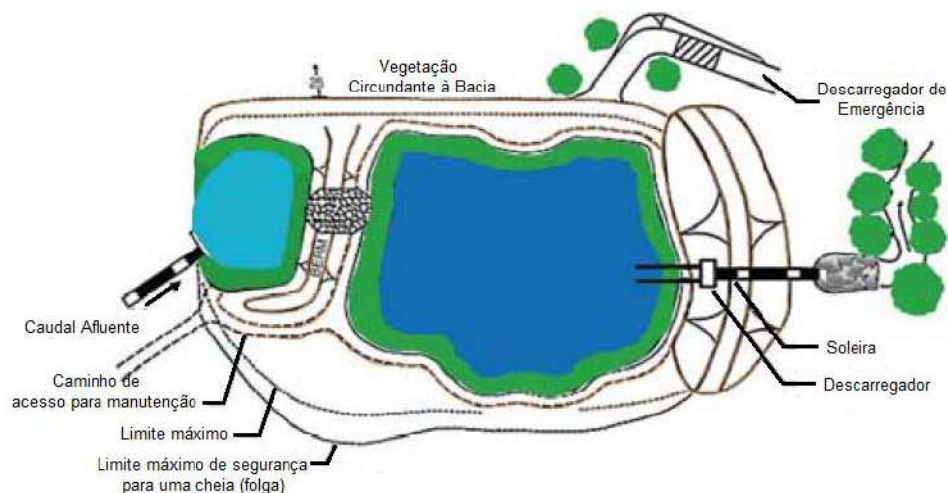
Planta de bacia de retenção (Adaptado de Correia (2007))
